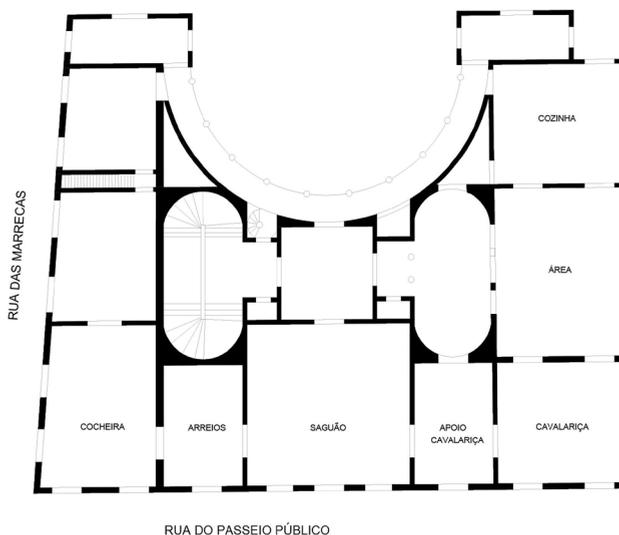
Reconstituição parcial da distribuição do pavimento térreo. Fonte: desenho da autora.
